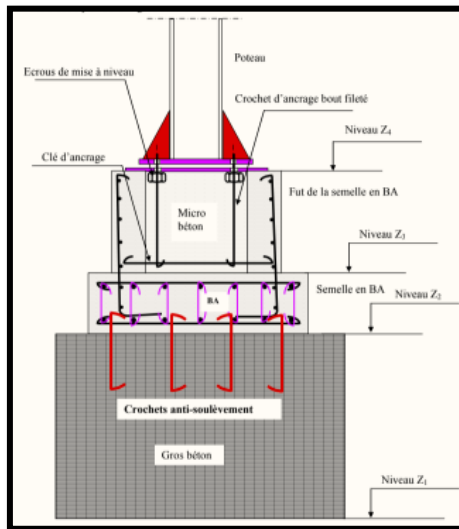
Exemple de poteau métallique avec fondation en béton armé
